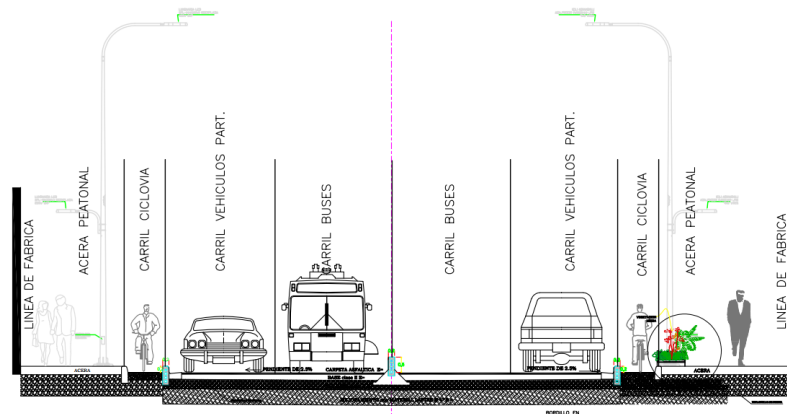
Sección típica Avenida. Quito 0+637 - 1+700
